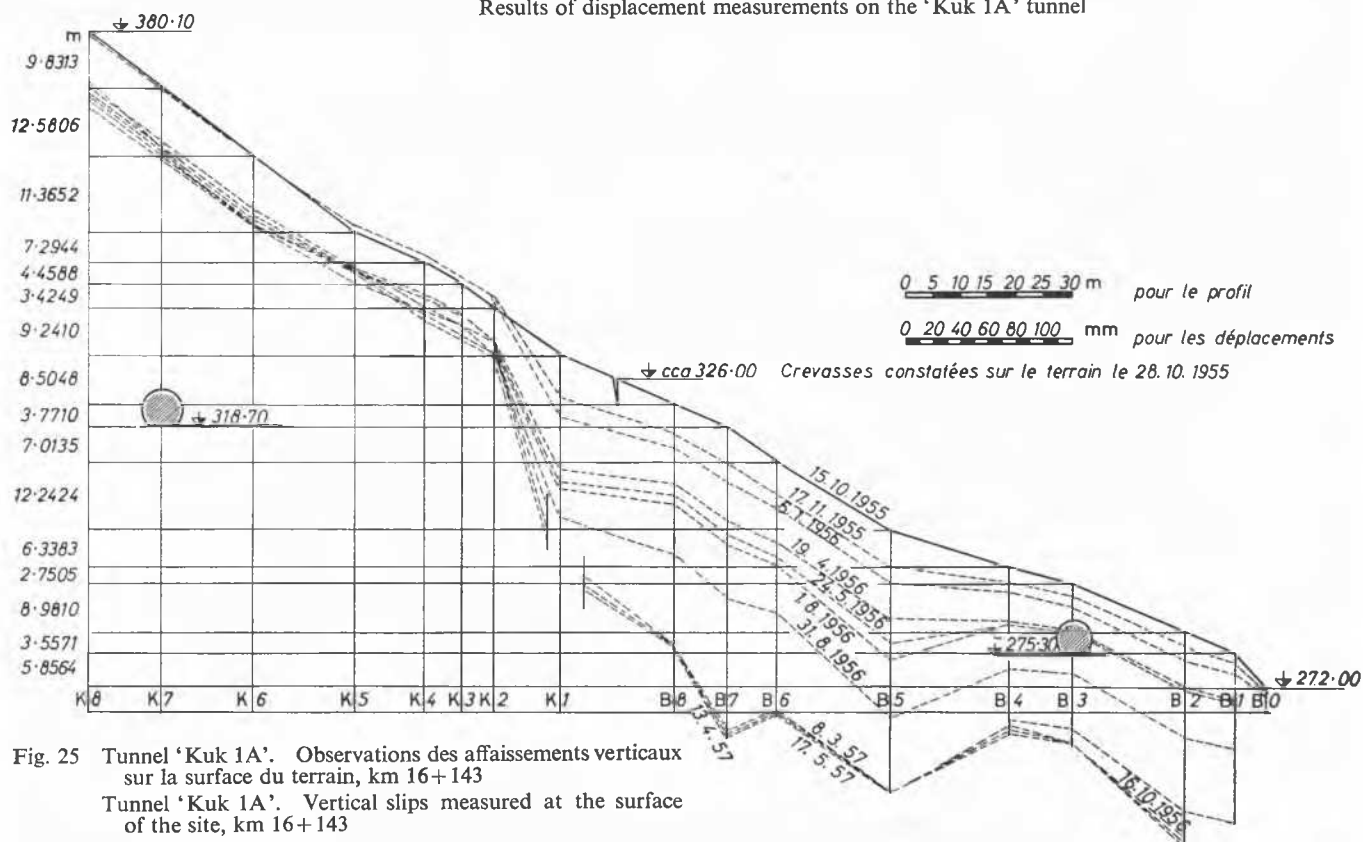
Tunnel 'Kuk 1A'. Observations des affaissements verticaux sur la surface du terrain, km 16+143
